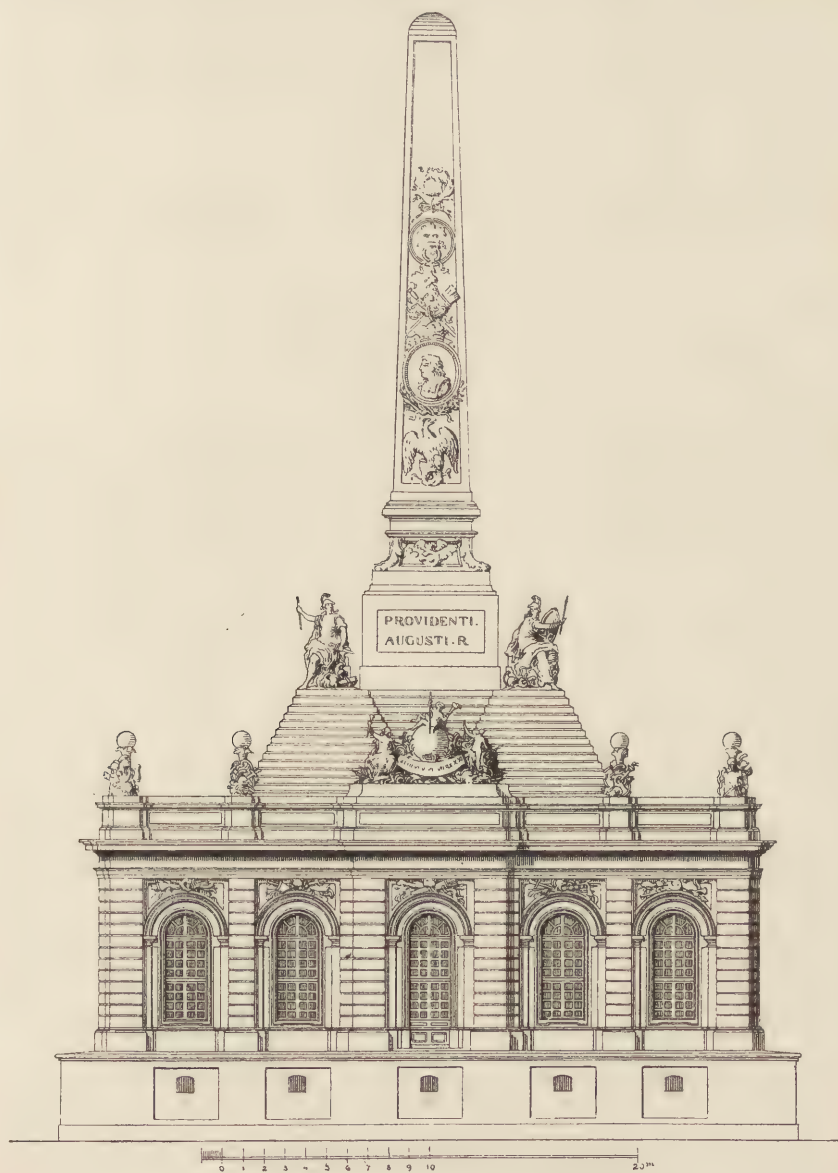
Blockhaus zu Dresden. Ursprünglicher Plan.
